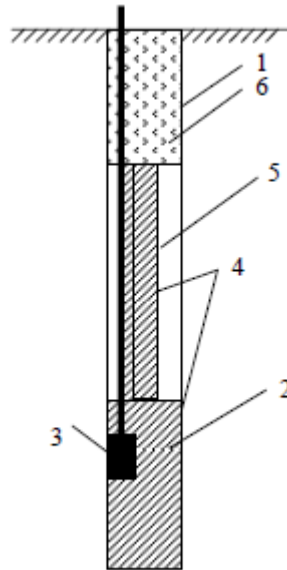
Конструкція свердловинного заряду ВР з радіальним зазором: 1 – свердловина; 2 - вибухова речовина, розміщена в нижній частині заряду; 3 - проміжний детонатор (ДПУ 830-Тл); 4 - рукав з полімерного матеріалу для формування заряду; 5 - вибухова речовина, розміщена у верхній частині заряду; 6 - набійка
